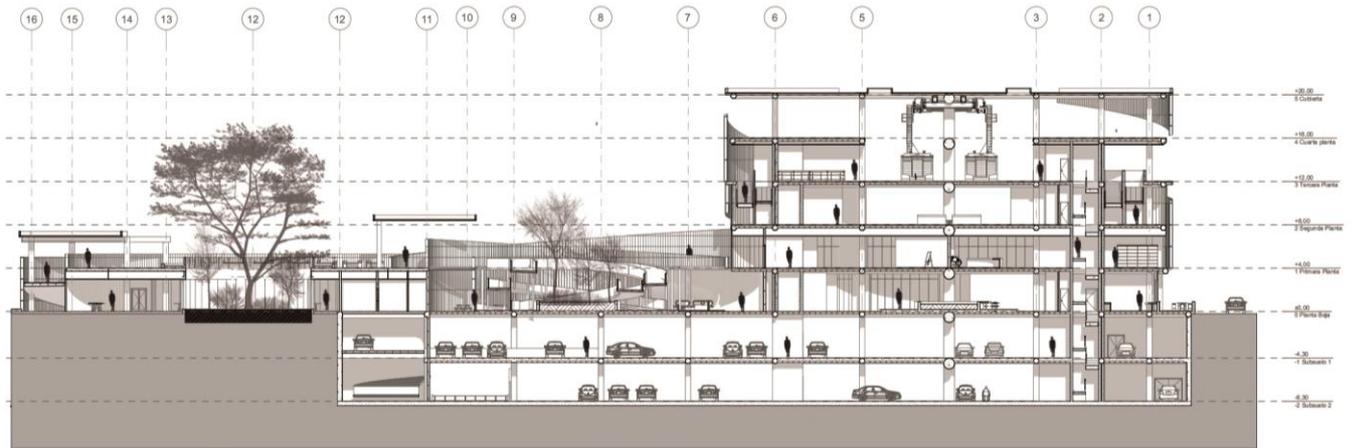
Corte longitudinal A-A'. Elaboración propia.
